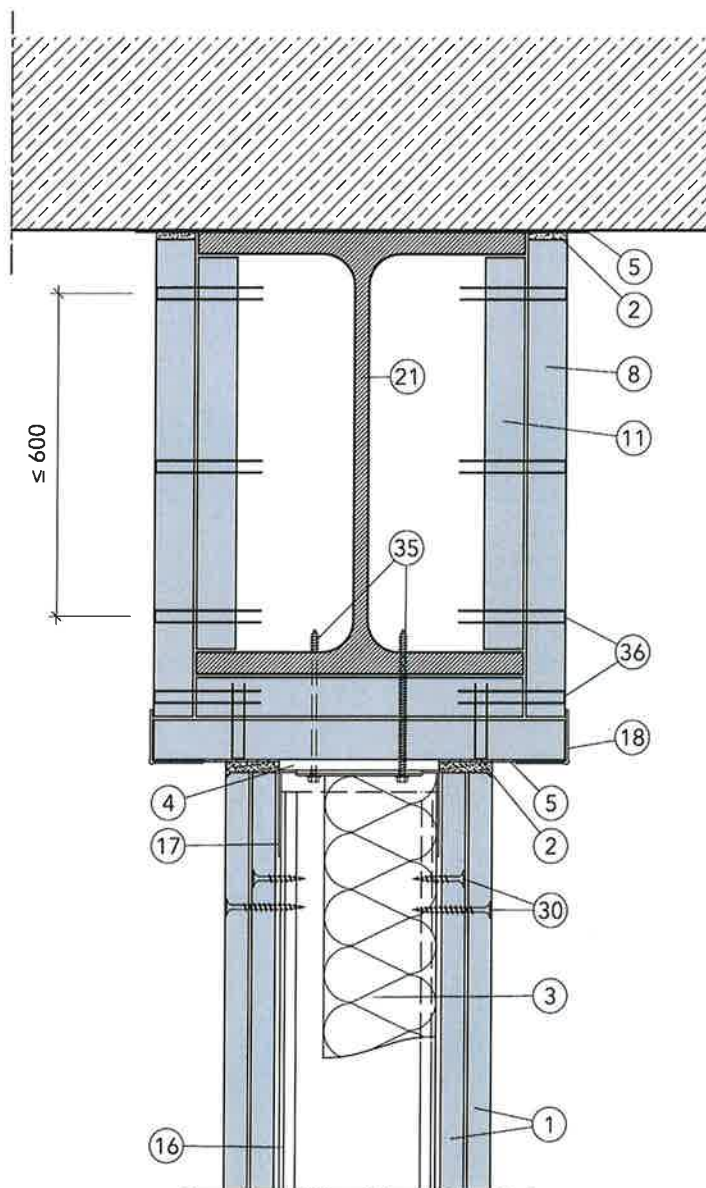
Vertikalschnitt Anschluss Stahlträger ohne Unterkonstruktion
